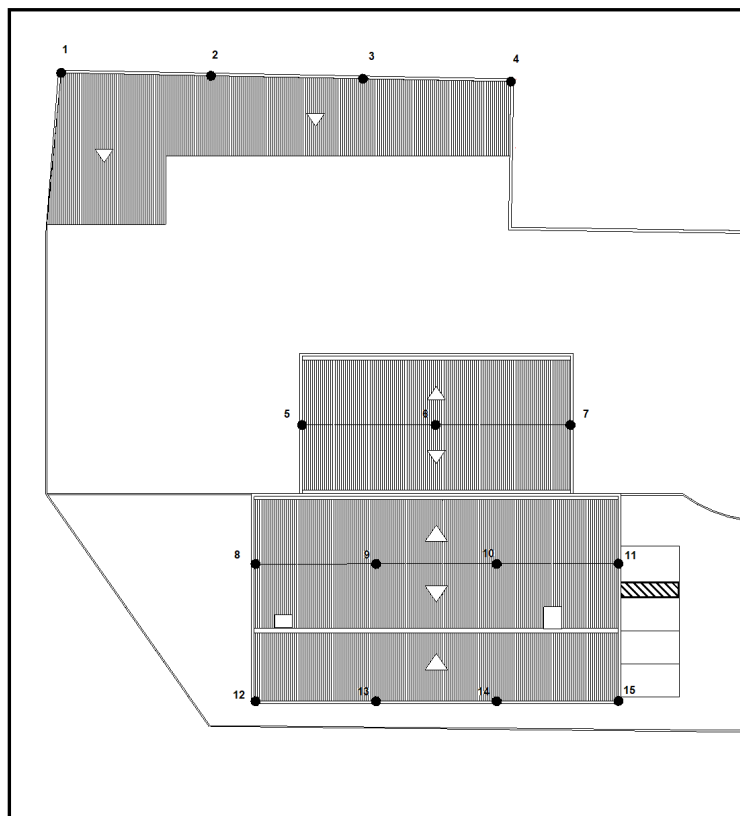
Disposição (Sugerida) Linha de Vida Horizontal
